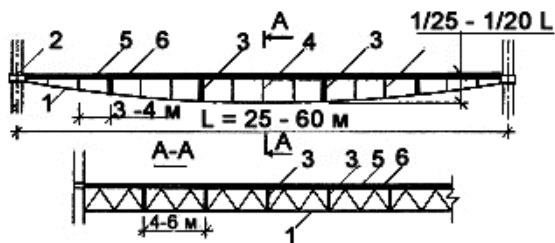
Сталебетонное перекрытие мембранного типа: 1 – стальная мембрана; 2 – опорный контур; 3 – сталебетонное ребро; 4 – ребро решетчатое (в виде фермы); 5 – профилированный настил; 6 – монолитный бетон
